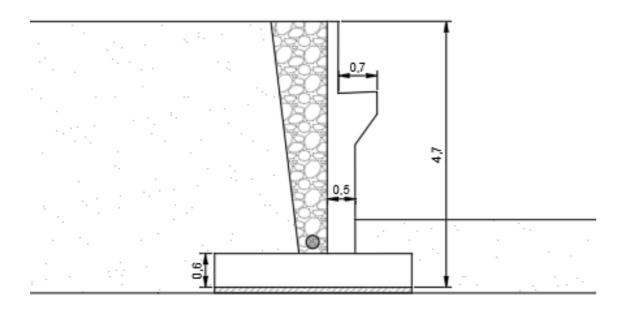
Geometría del estribo de España (Fuente: Propia)
